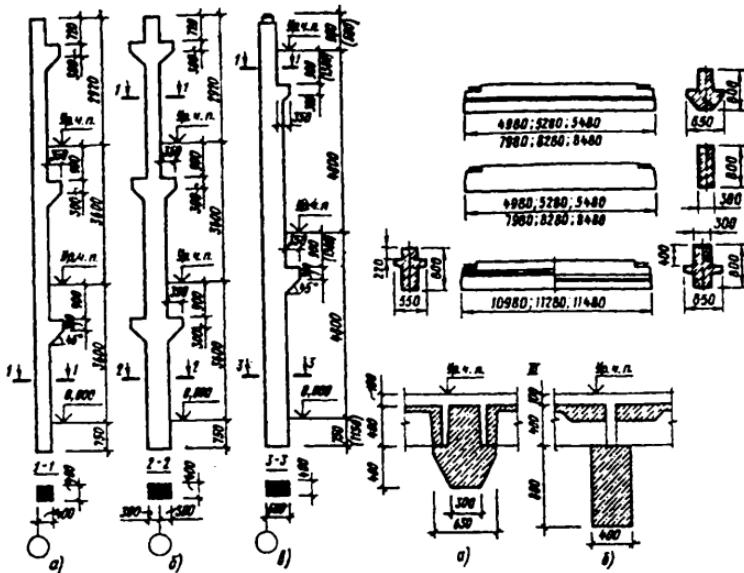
Элементы балочного железобетонного каркаса при опирании ригелей на консоли колонн (при сетках осей 6×6, 6×9 и 6×12 м):
